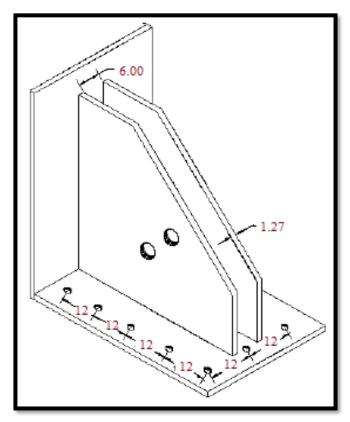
Detalle final de la plancha metálica. Fuente: Propia.
